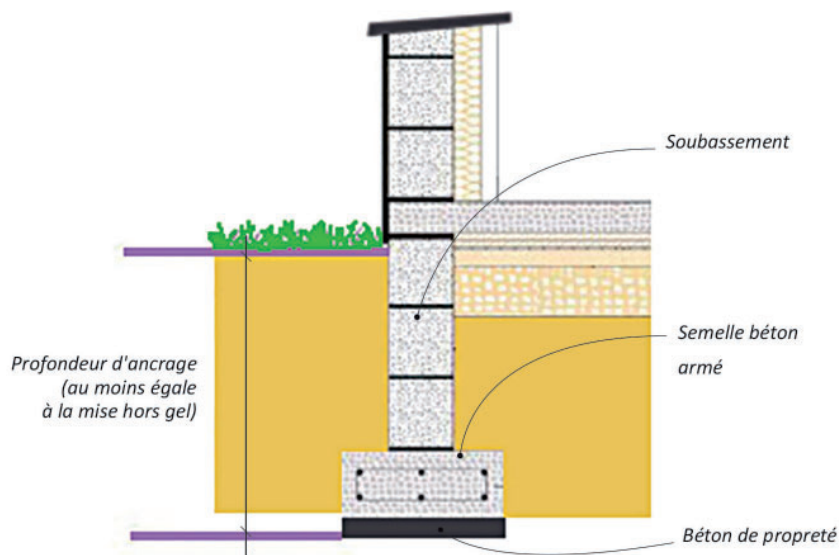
Exemple de fondation superficielle de type semelle filante
